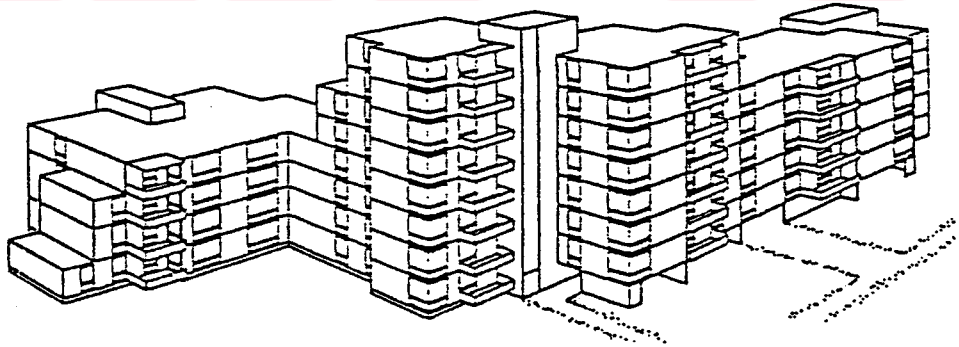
ESTON, Prefabrike Betonarme İskelet + Panel Sistemle
